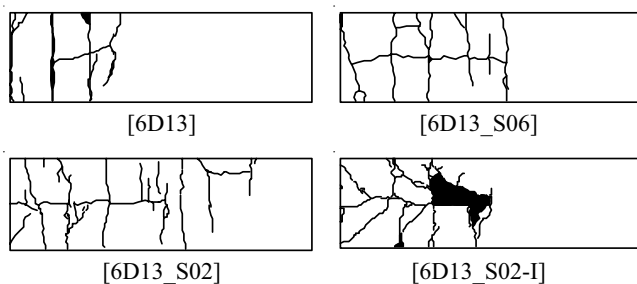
試験体上面荷重終了時ひび割れ状況
